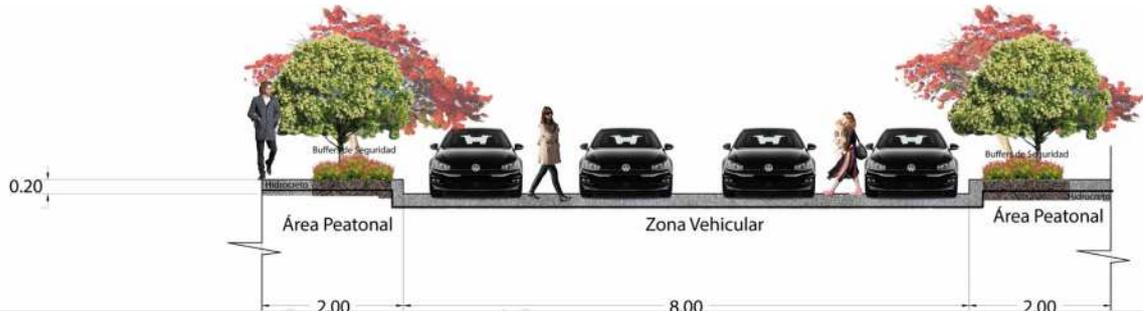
; Corte C-C' propuesta de diseño de paisaje de la Avenida Ermita Iztapalapa.
